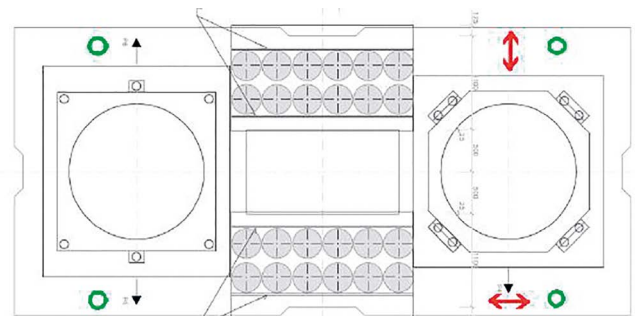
Sistema de gateo para la reparación y reemplazo del apoyo dañado en pila 5.
